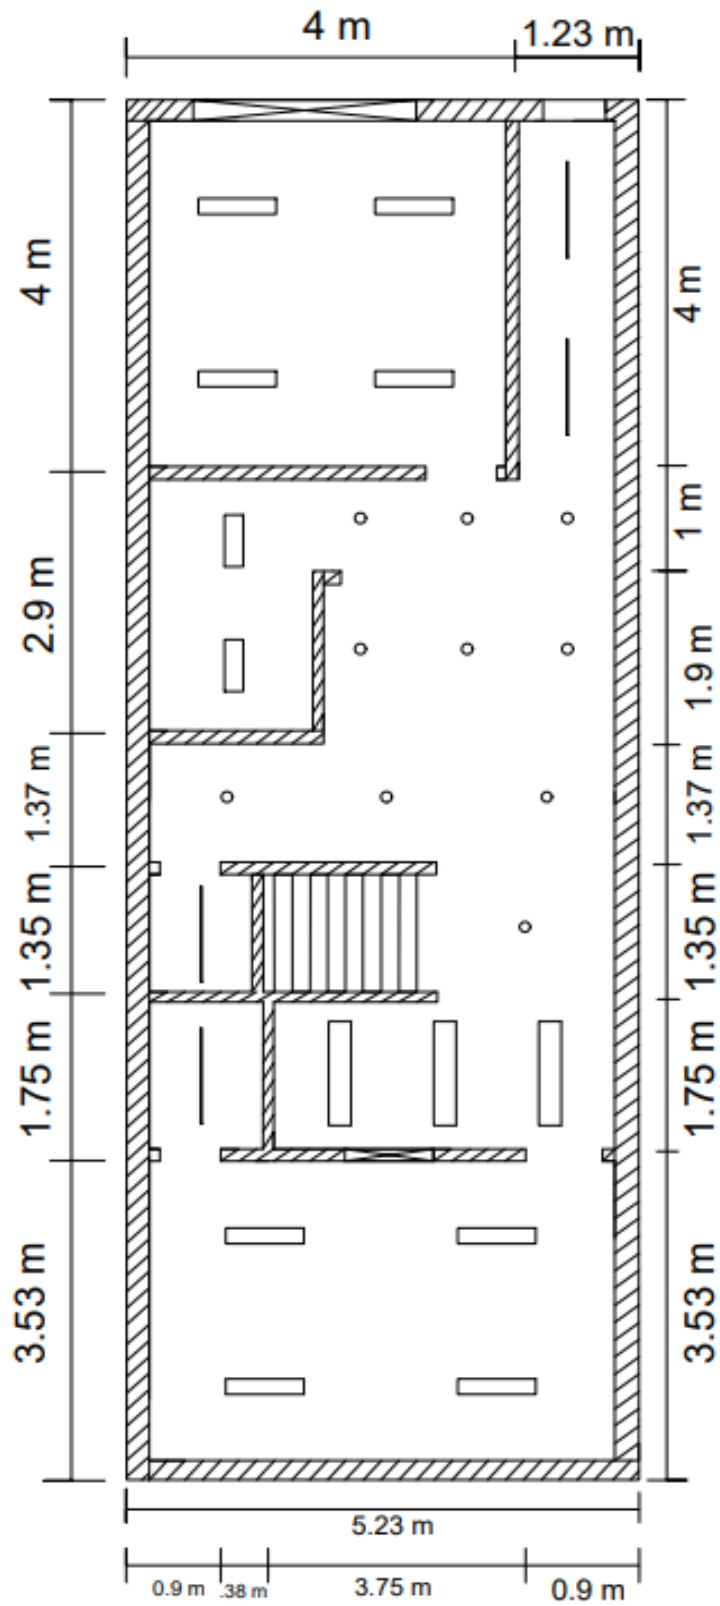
Plano de distribución de luminarias planta baja propuesta 3
